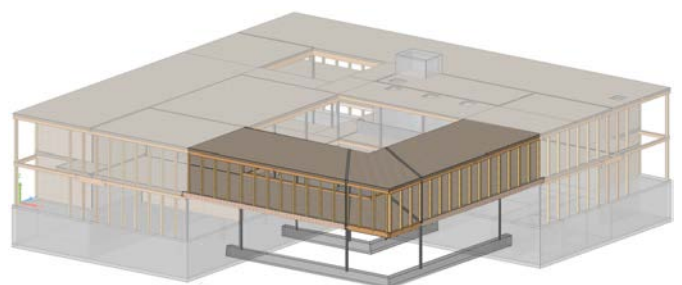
Darstellung Brückenbau mit auskragender Grundrissecke (Quelle: B + G)
